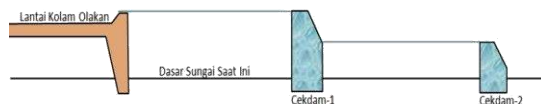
Sketsa Konstruksi Perbaikan Kolam Olak
